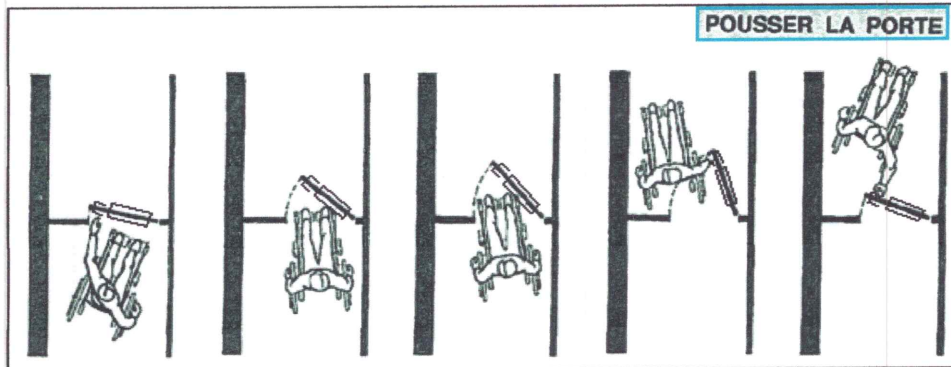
Positions du fauteuil roulant pour pousser la porte
